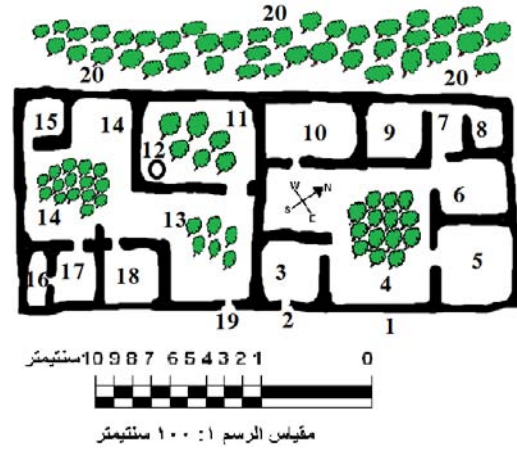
قرية القصار - مسقط أفقي لمنزل رقم (٢)
